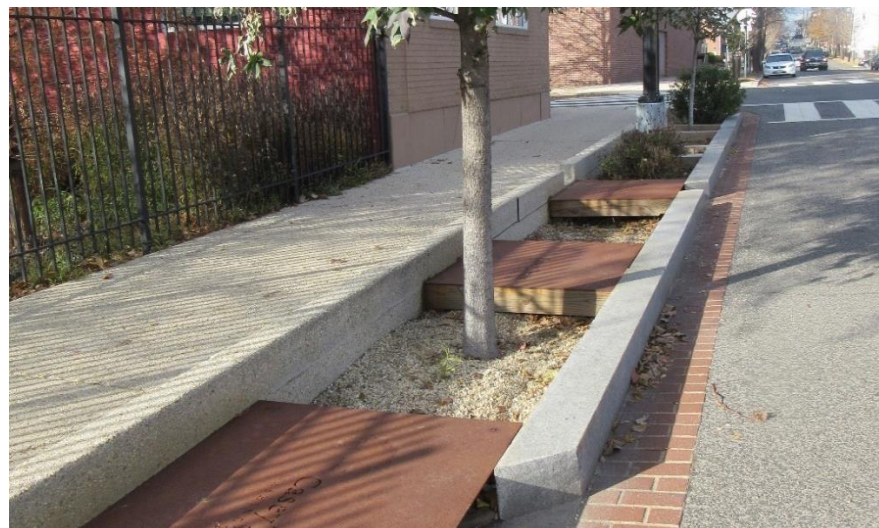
Alcorques estructurales en Washington DC (EEUU).
